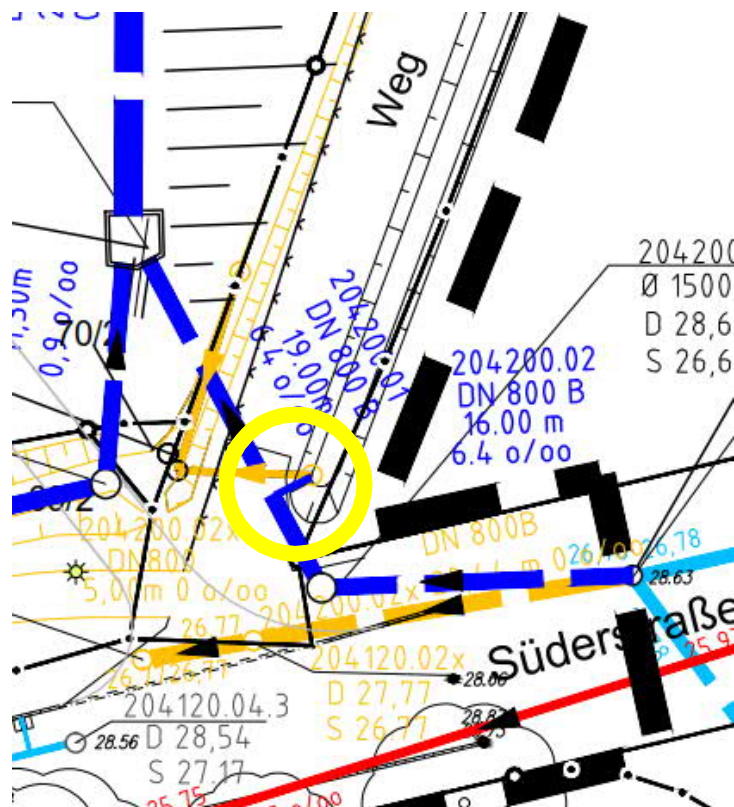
Auszug aus Lageplan RW-Behandlung Einleitestelle 17, 18
